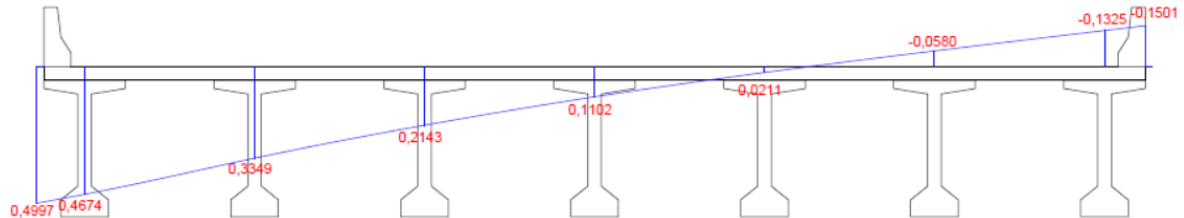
Deformada da laje com a aplicação da carga vertical na viga 1.
